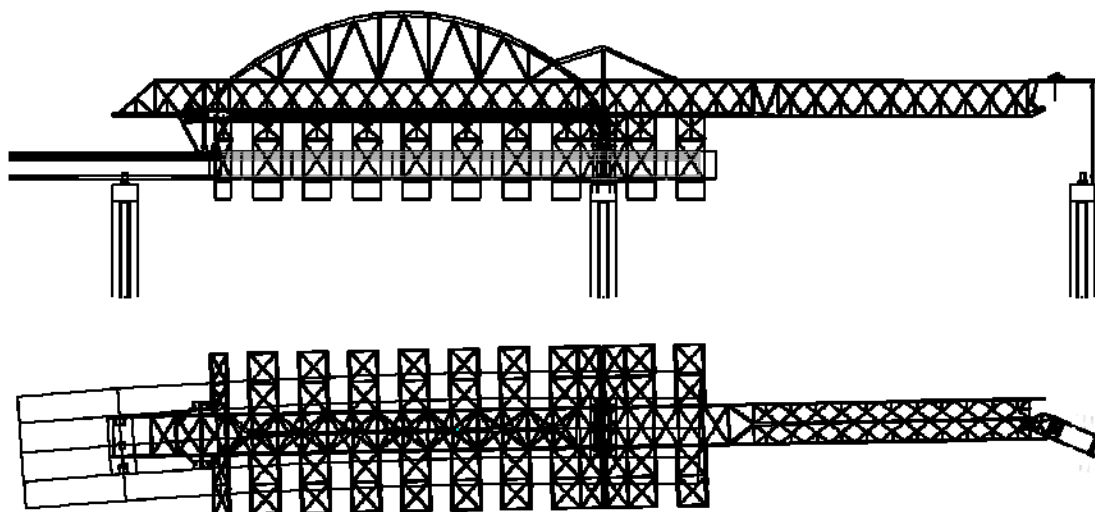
Cembre M50-S: alçado (cima) e planta (baixo)
